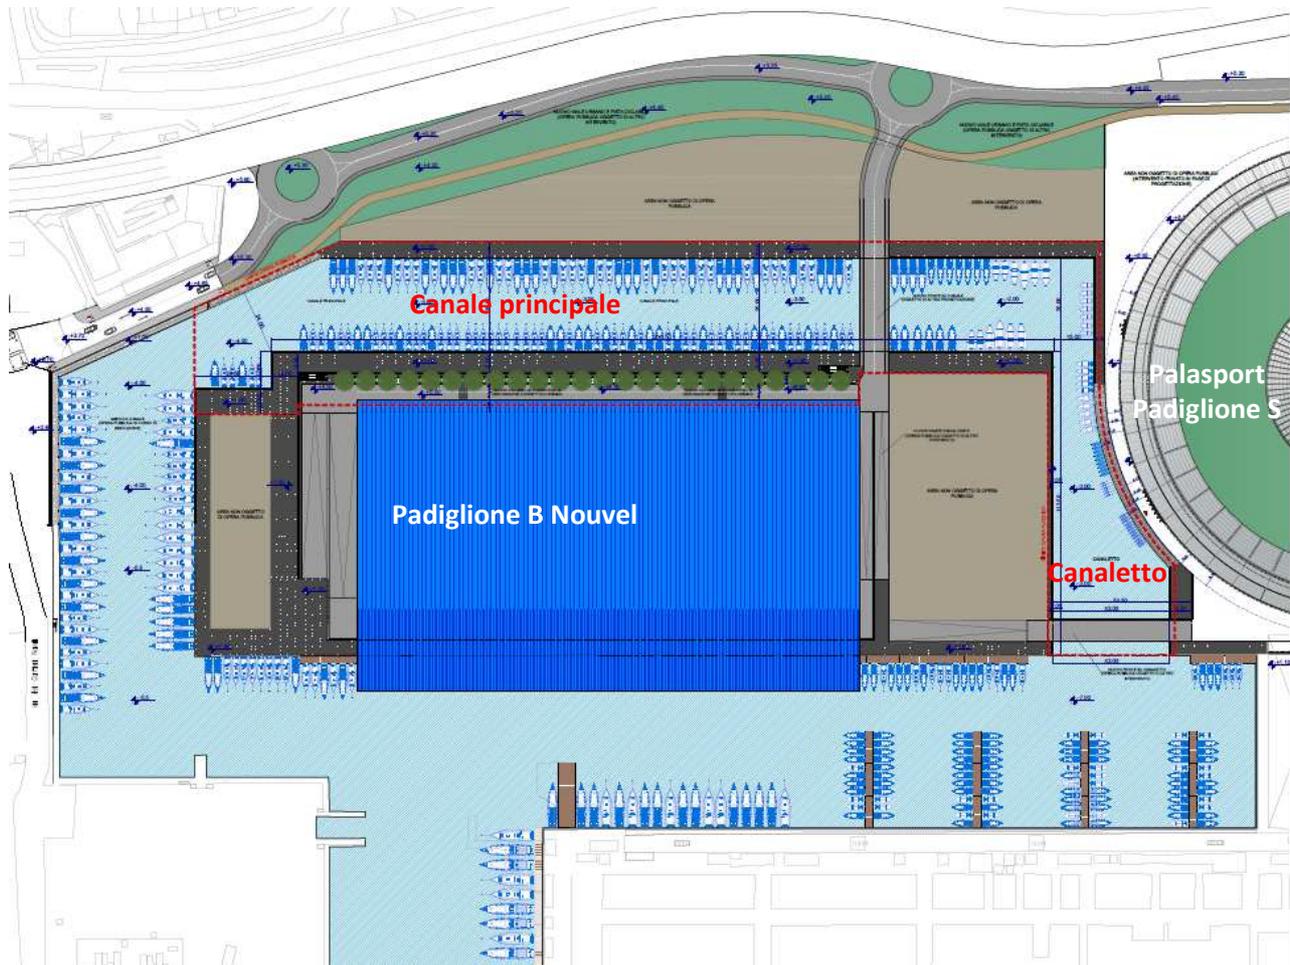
PFTE "Canali ed opere pubbliche connesse": Planimetria generale di inquadramento progetto – Stralcio elaborato Ar-T02
